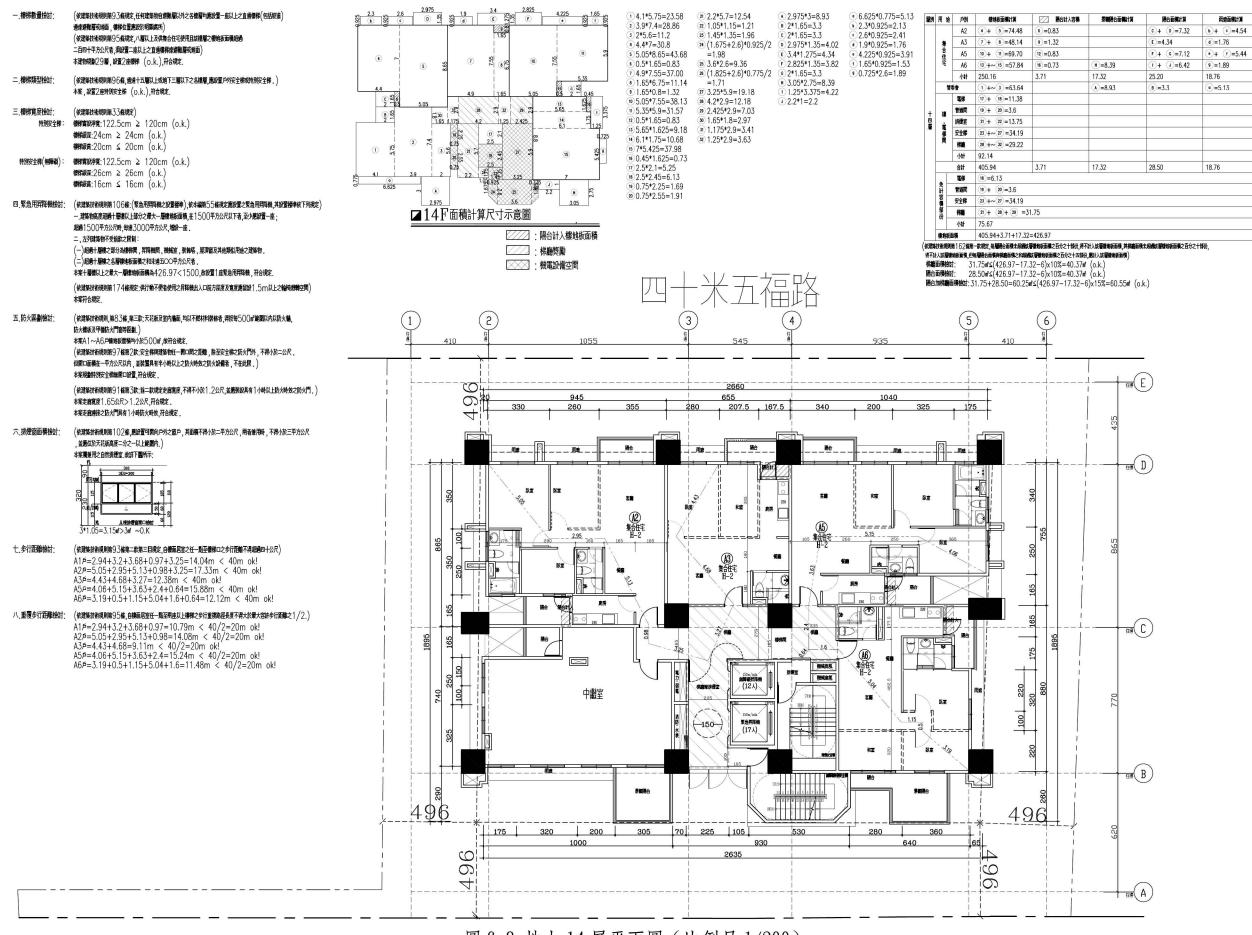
地上 14 層平面圖 (比例尺 1/200)
